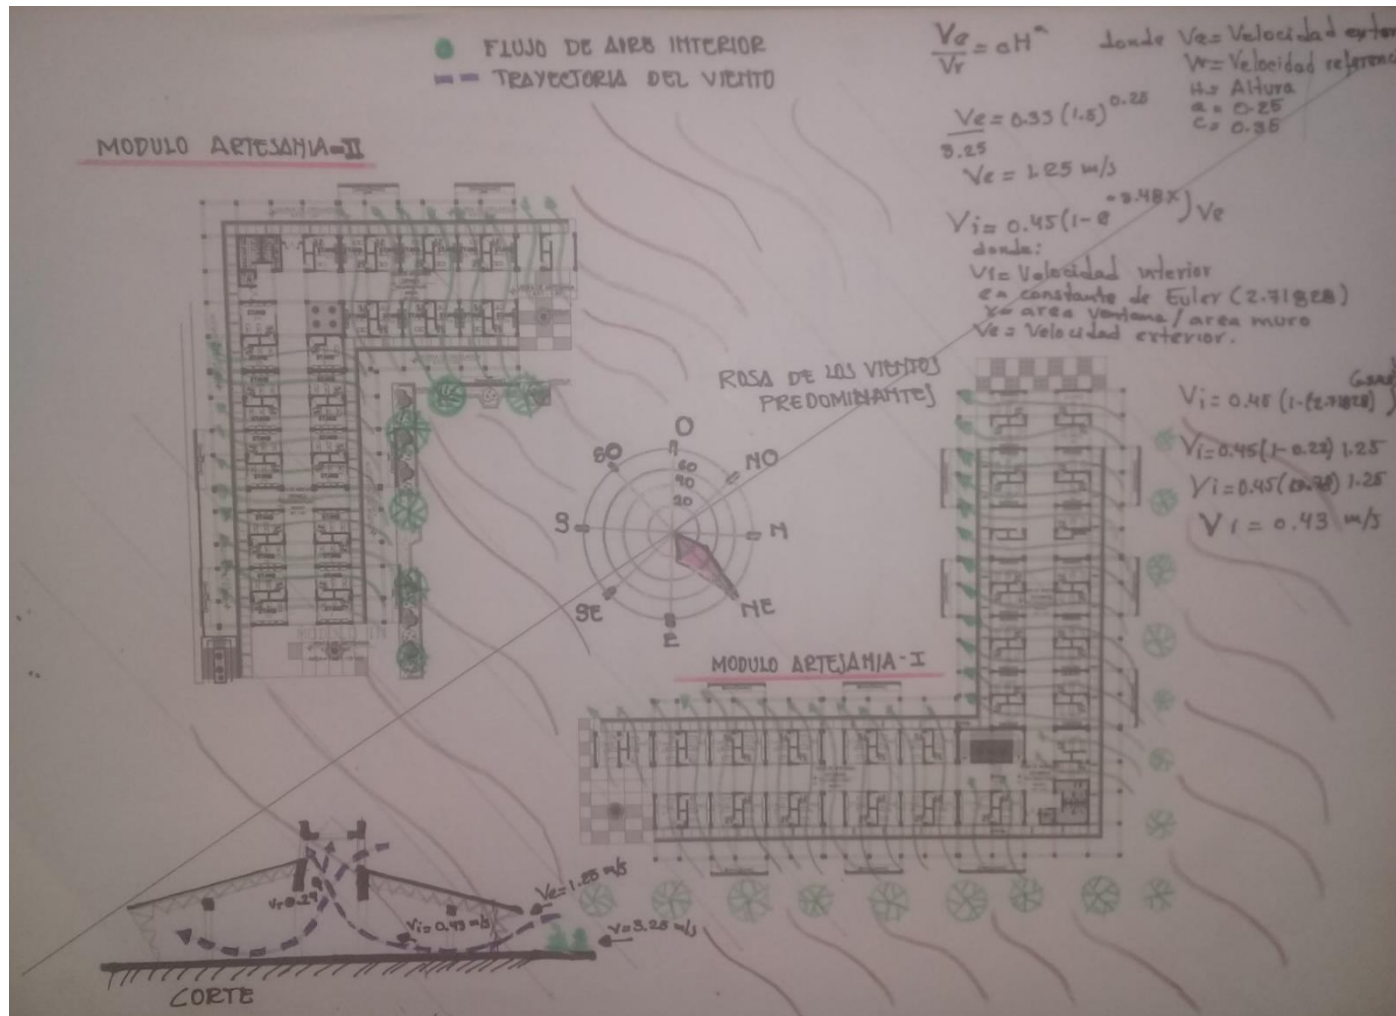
Elementos de protección de vientos- modulo artesanía.
